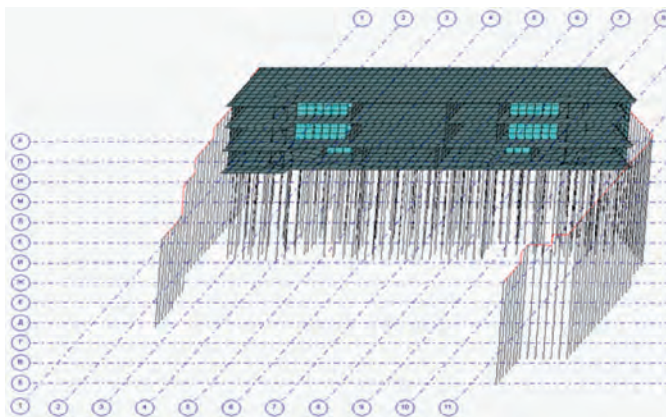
Загальний вид просторової розрахункової моделі обгороджування котловану і етажерки стилобату.
